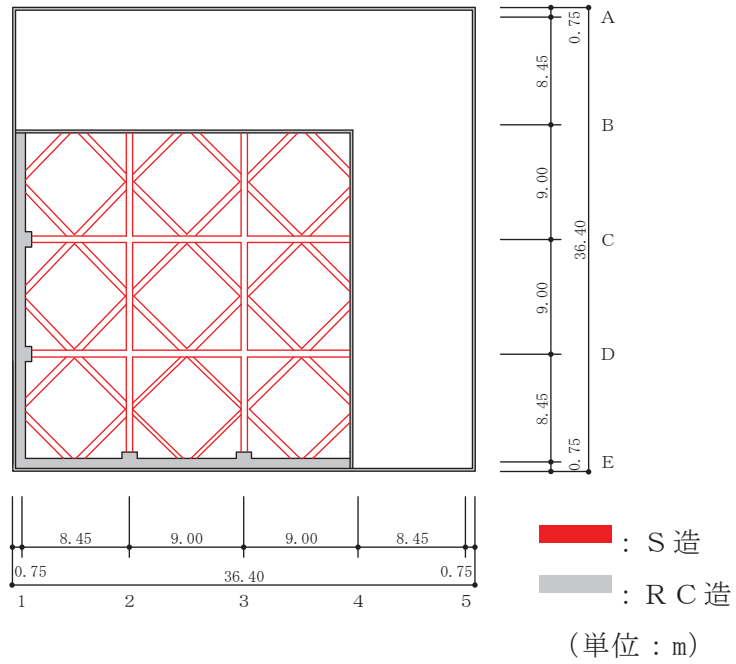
(5) 緊急時対策建屋の概略平面図 (0.P.75.9m)
